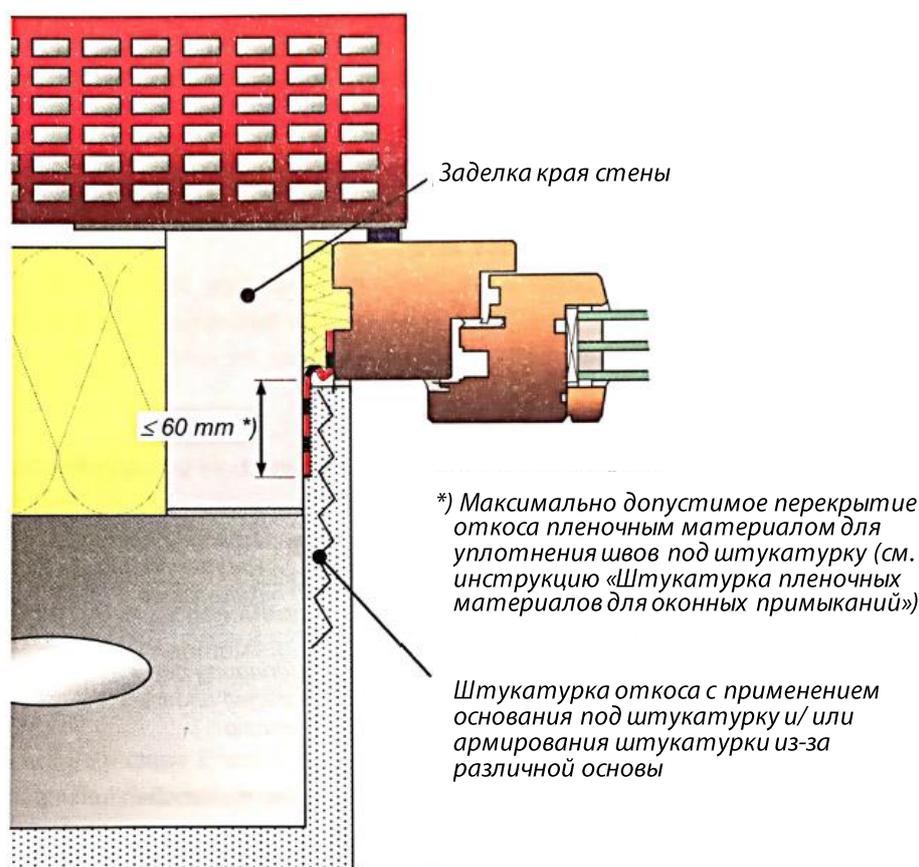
Пример монтажной ситуации деревянного оконного блока в двуслойную стену с зоной утеплителя. Со стороны помещения уплотнение между оконным блоком и заделкой края стены пленочным материалом для уплотнения швов. Со стороны строительной организации необходимо выполнение откосов с учетом названных пунктов.
